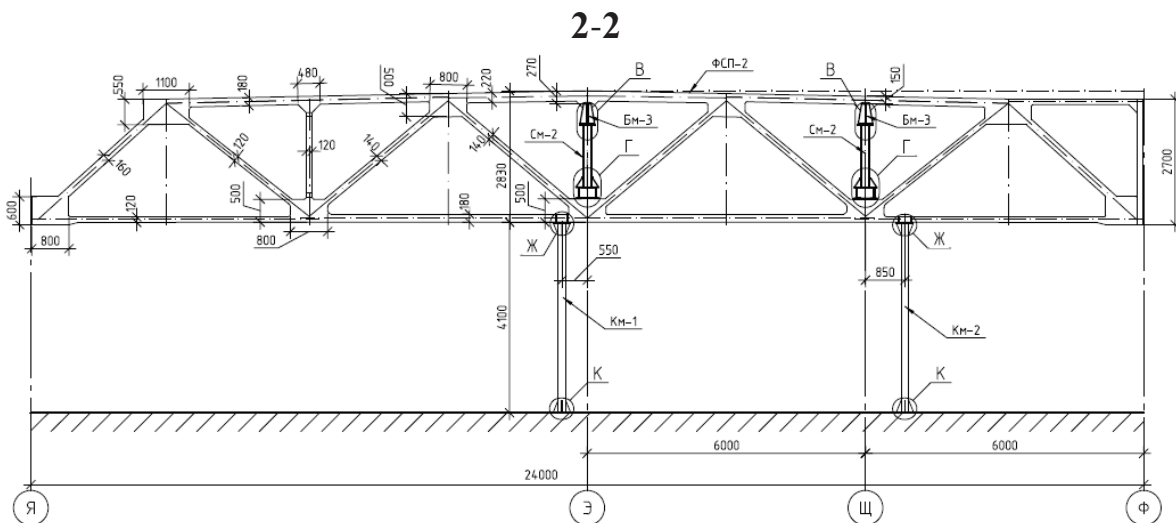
Розріз по каркасу будівлі, влаштування колон підсилення ферми ФСП-2, обпирання металевих конструкцій рами під крани для монтажу лінії R-7
